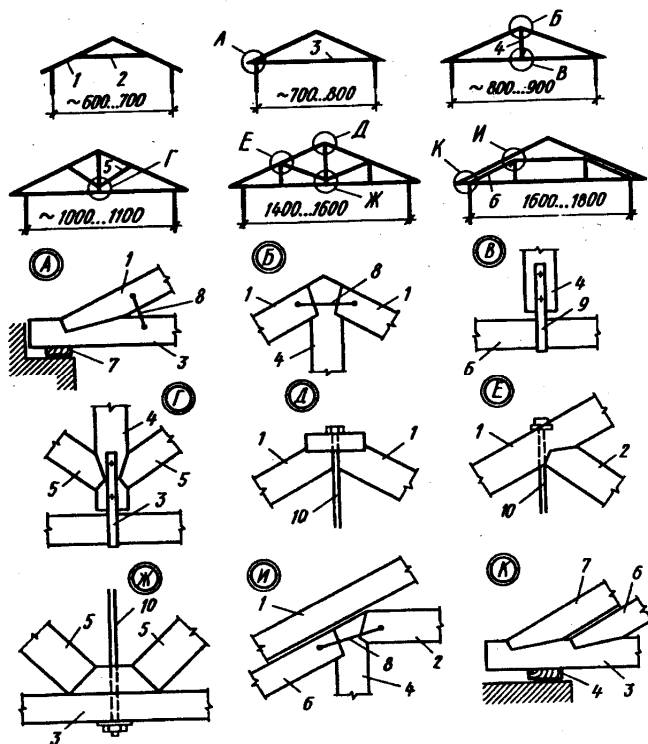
Схемы деревянных и металлодеревянных ферм (висячих стропил) и детали узлов:
